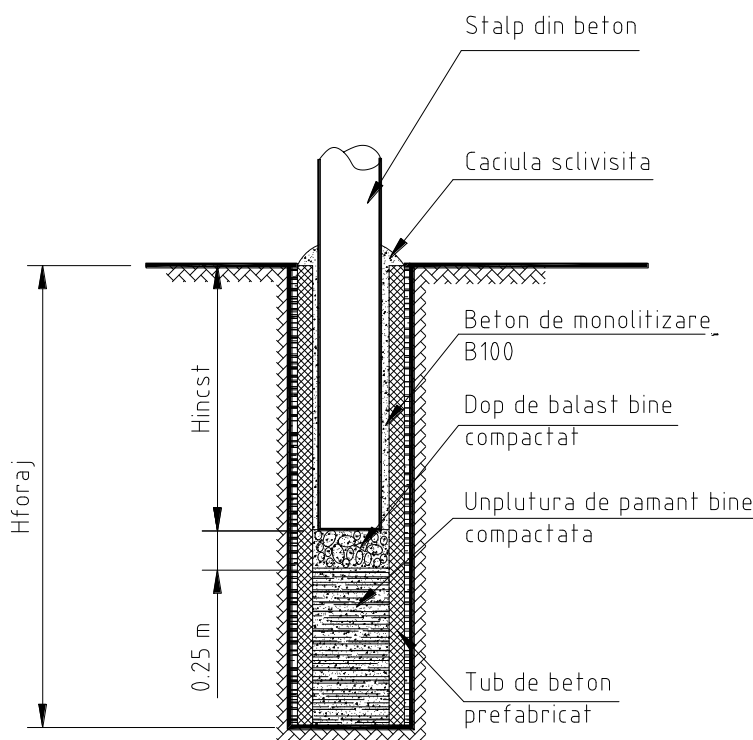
Fundație prefabricată coloană, montată în groapă forată
